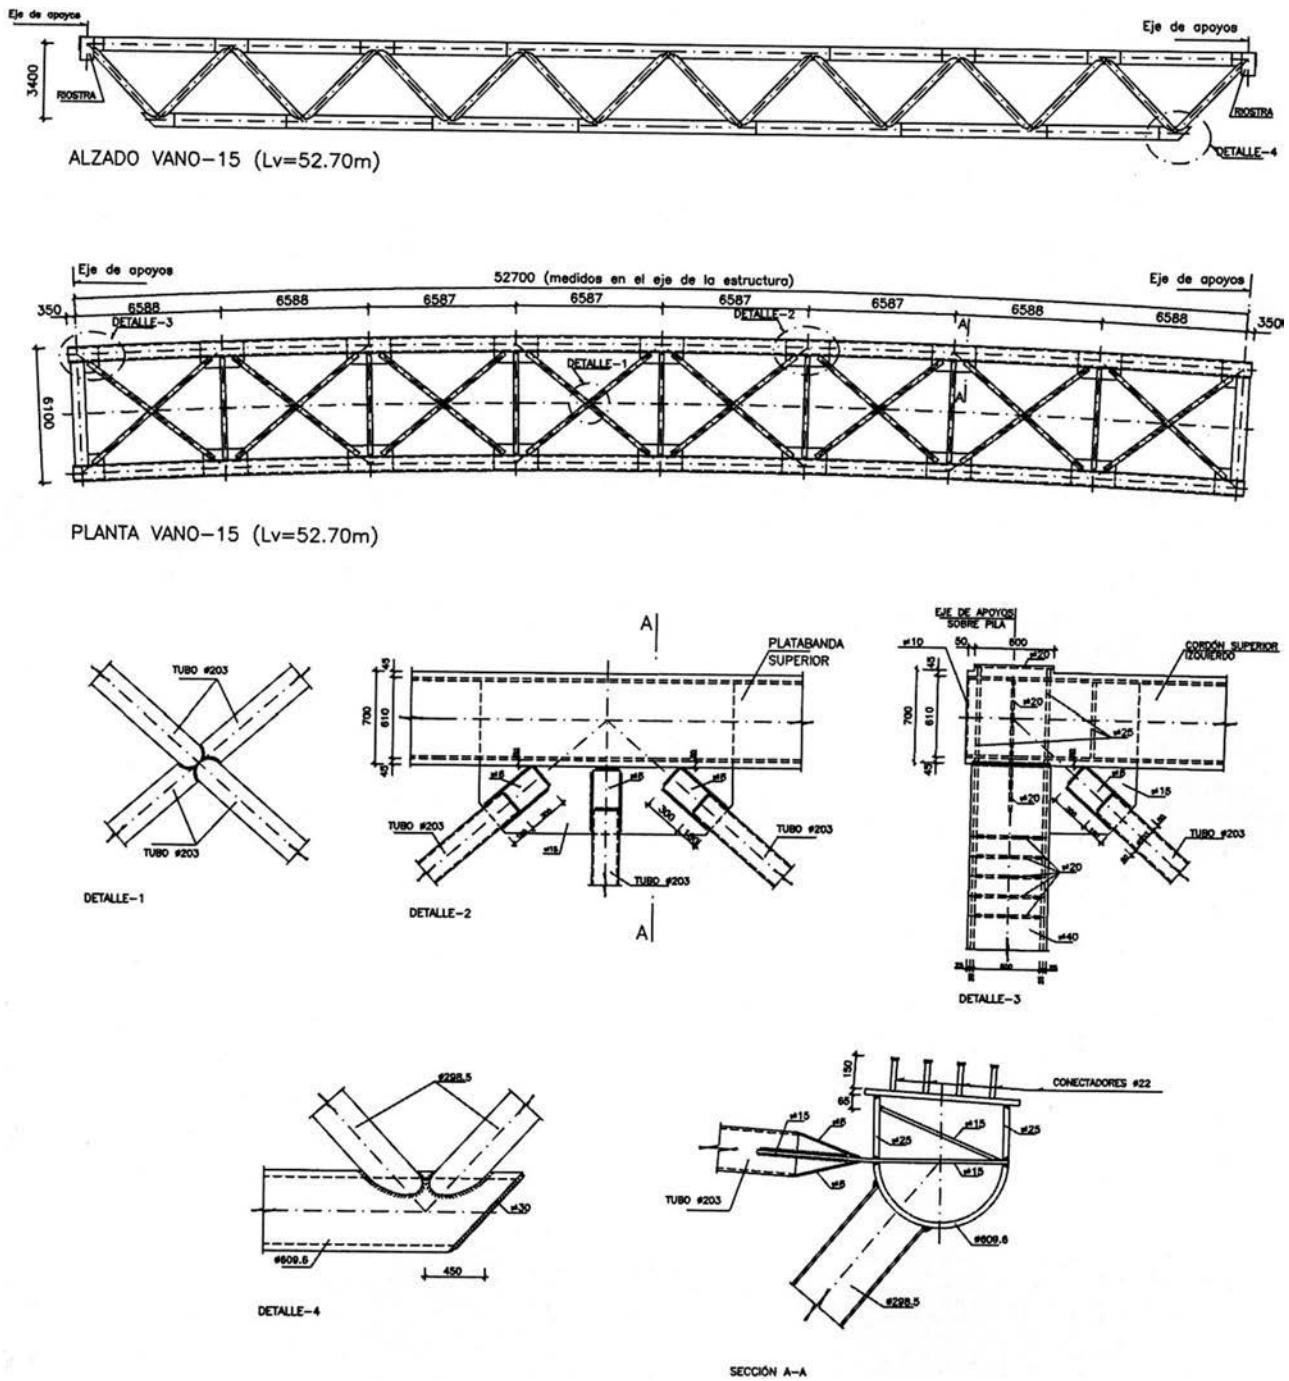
Celosía metálica de un vano de 52,70 m de luz. Alzado, planta y detalles de nudos.
